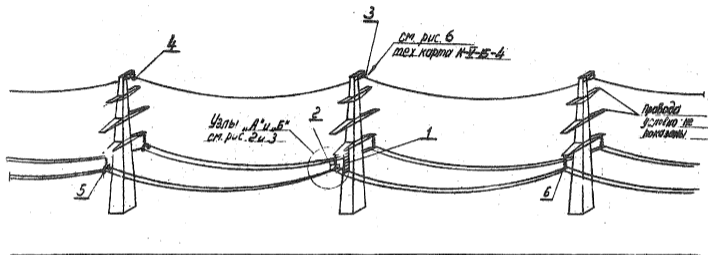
Перекладка проводов и грозозащитного троса без опускания их на землю
